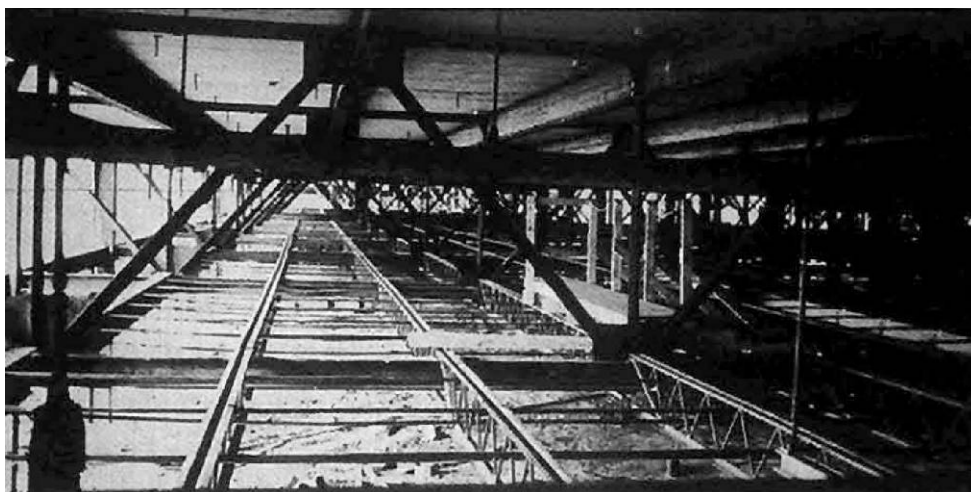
Woodhull Medical Center de Brooklyn en Nueva York (EE.UU.). Vista de la planta intersticial en construcción.
